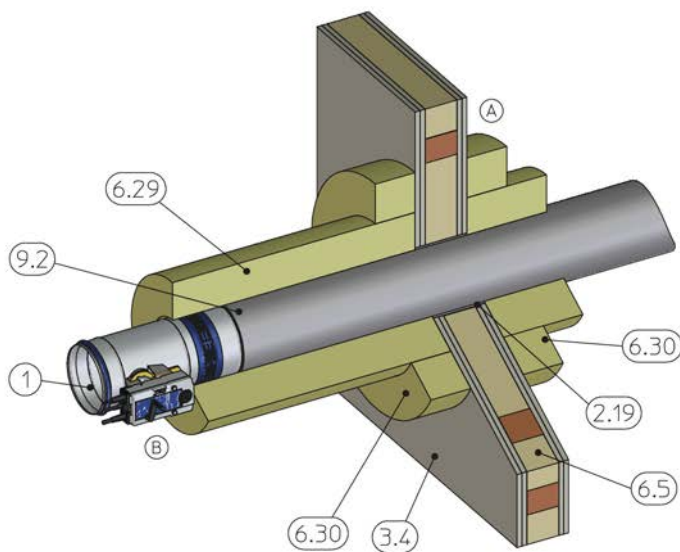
Installazione a secco in una parete divisoria leggera con struttura in legno e altro materiale, con kit di installazione TQ / TQ2
